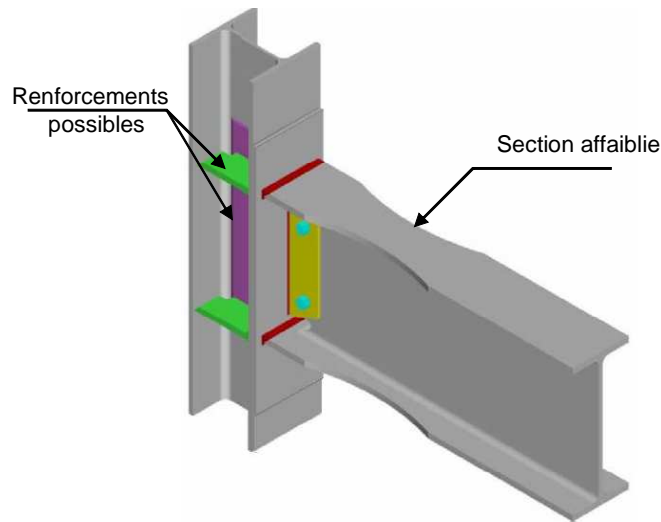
Proposition de renforcement de poteaux au droit d'assemblage et réalisation d'une zone à plastification choisie [17]
